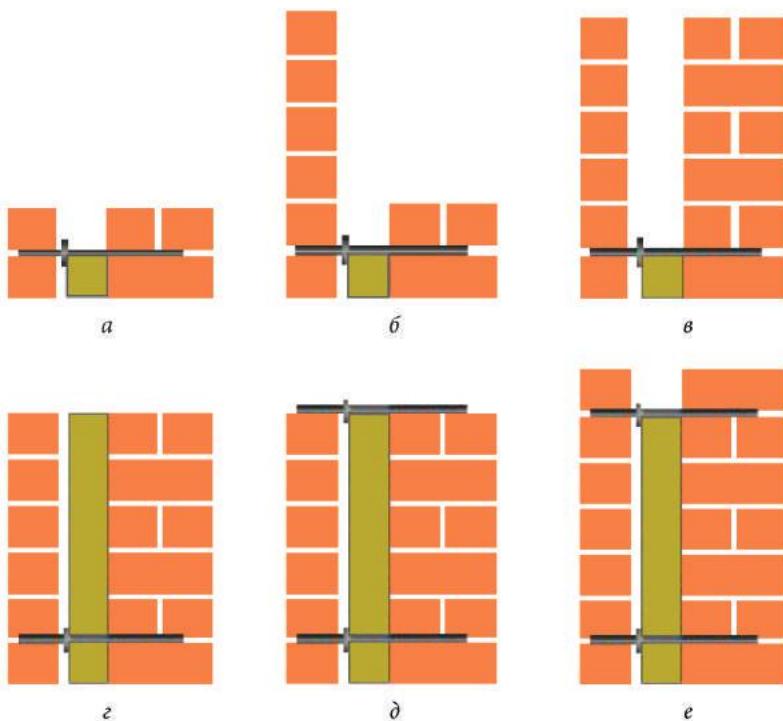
Схема кладки стены с отделочным слоем из кирпича: а — исходное положение; б — укладка наружного слоя; в — укладка внутреннего слоя; г — укладка утеплителя; д — установка гибких связей; е — укладка одного ряда кирпичей поверх связей в обоих слоях
